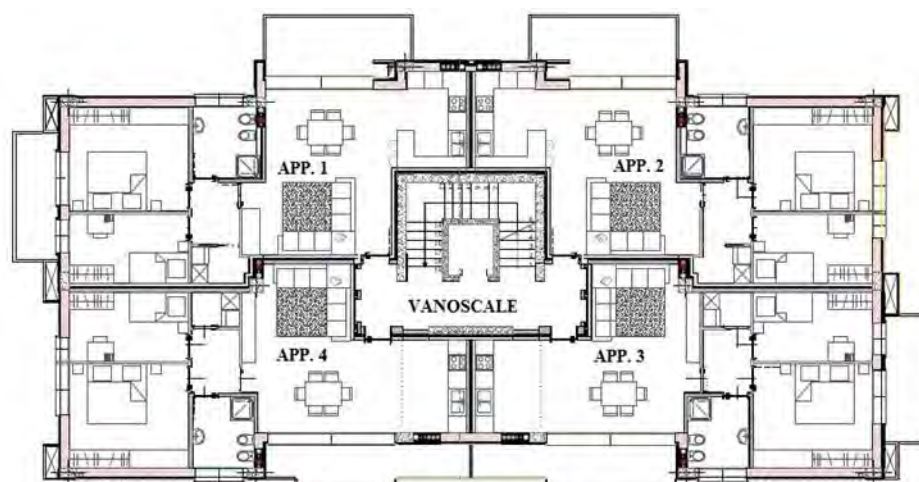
Planimetria del secondo piano dell'utenza multifamiliare.
